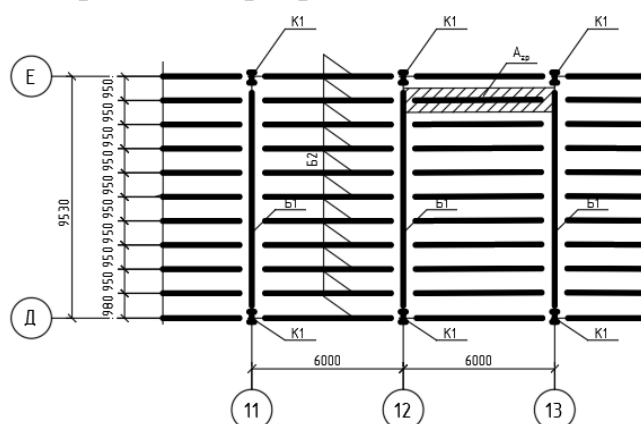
Грузовая площадь металлической балки перекрытия
